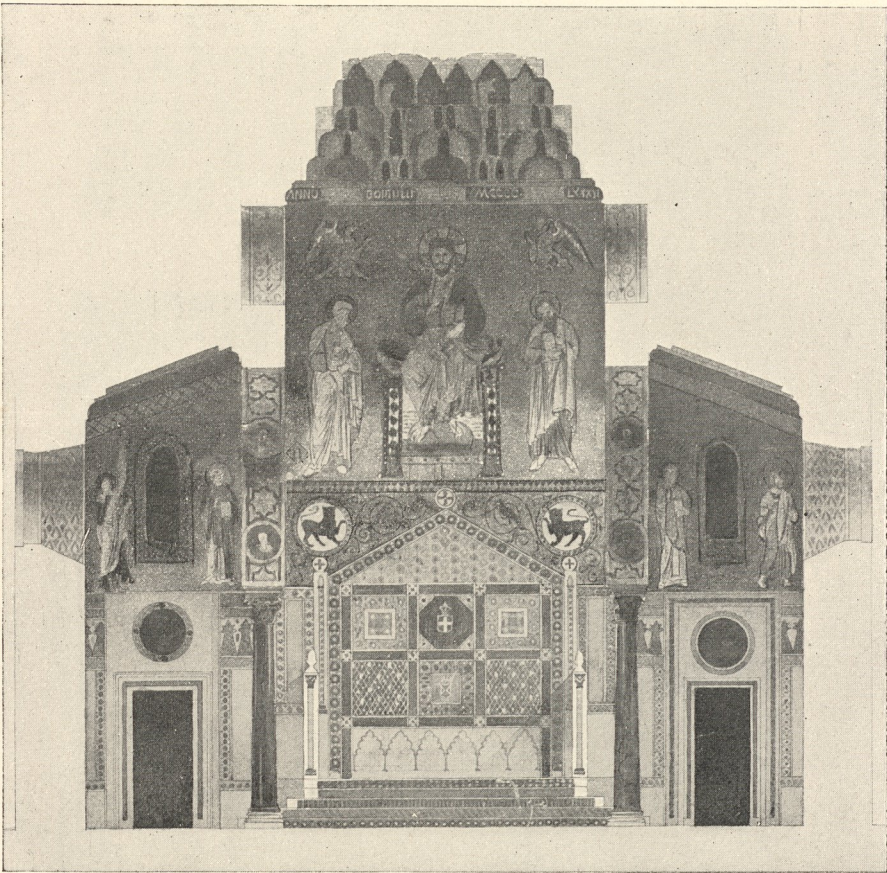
Coupe transversale de la chapelle Palatine de Palerme.
